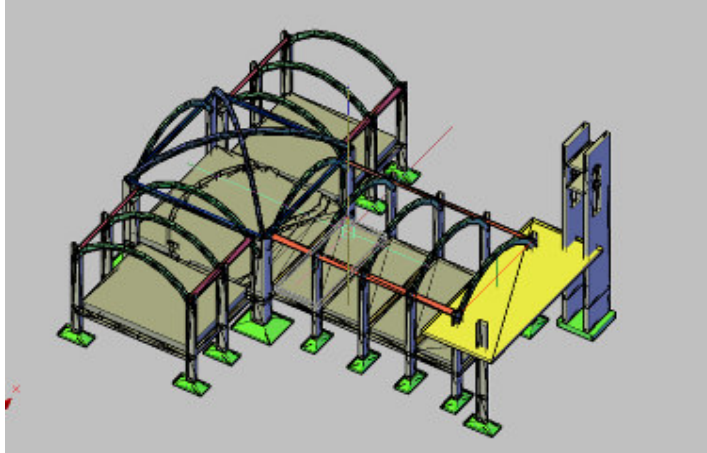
7 Vista Izquierda (Perspectiva llena) Fundación , Vigas , Tabiques , losa, Vigas de Borde y Arcos
